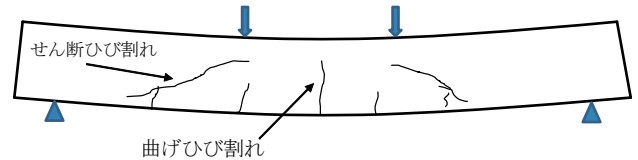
鉄筋コンクリート部材に発生する曲げひび割れとせん断ひび割れ
